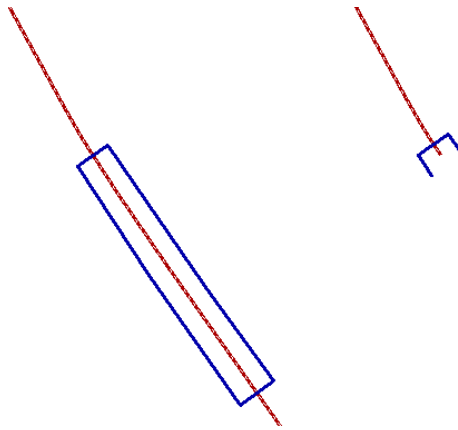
Tunnelemente. Links: Tunnel mit zwei Portalen. Rechts: Ein Tunnelportal, Tunnellänge > 1.5km (oder explizit unter die Element-Attribute definiert).
